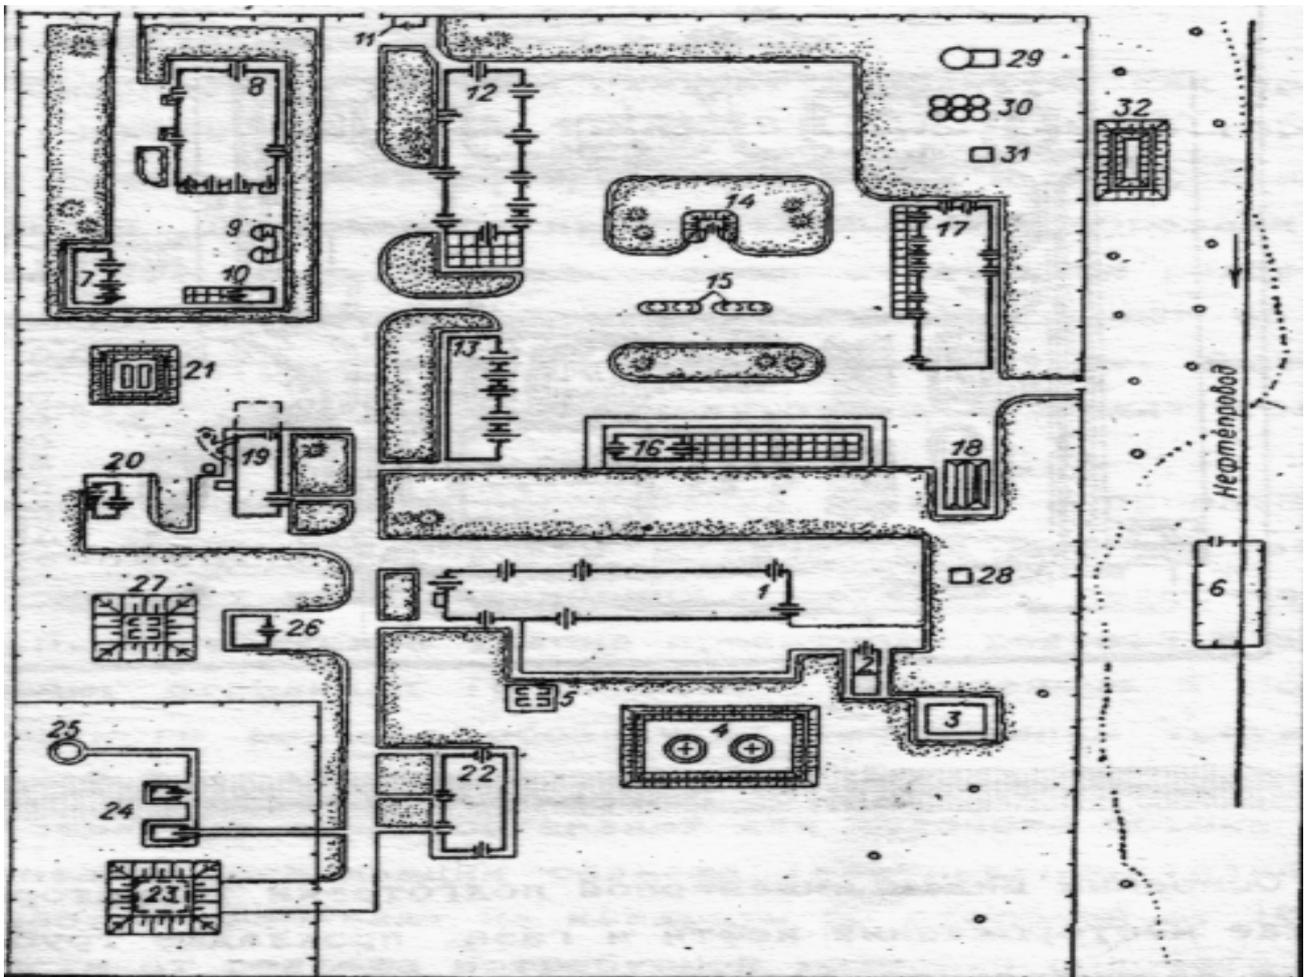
Схема генерального плана промежуточной НПС нефтепровода :
